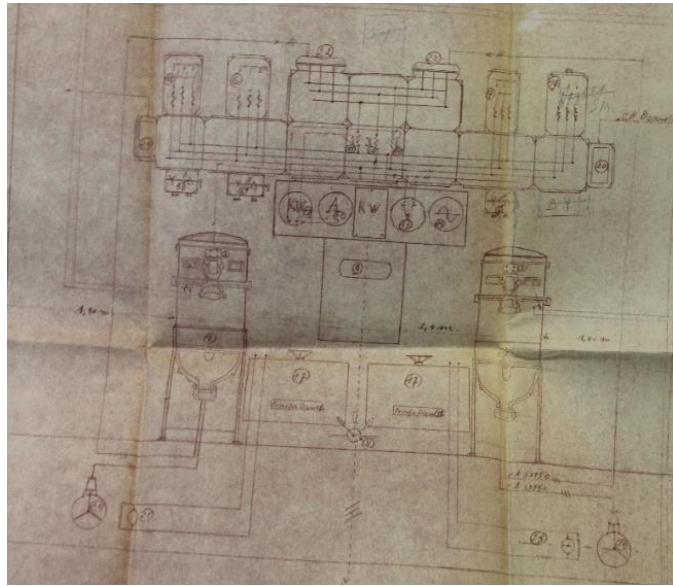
Plan de remplacement du tableau « TC », WHI, fond QGT, boîte 74.
